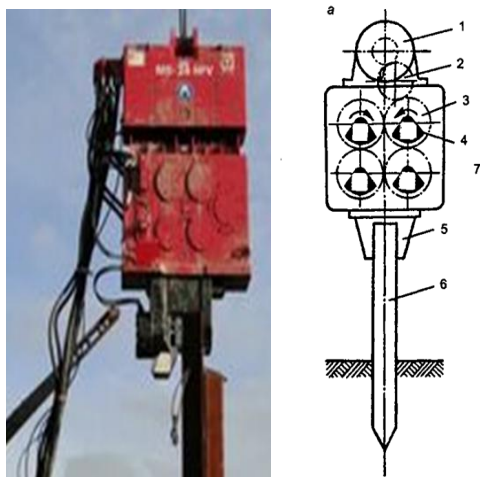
Низкочастотный вибропогружатель: 1-приводной электродвигатель; 2- промежуточная шестерня; 3- система синхронизирующих цилиндрических шестерен; 4- дебалансные валы; 5- наголовник; 6- свая.
